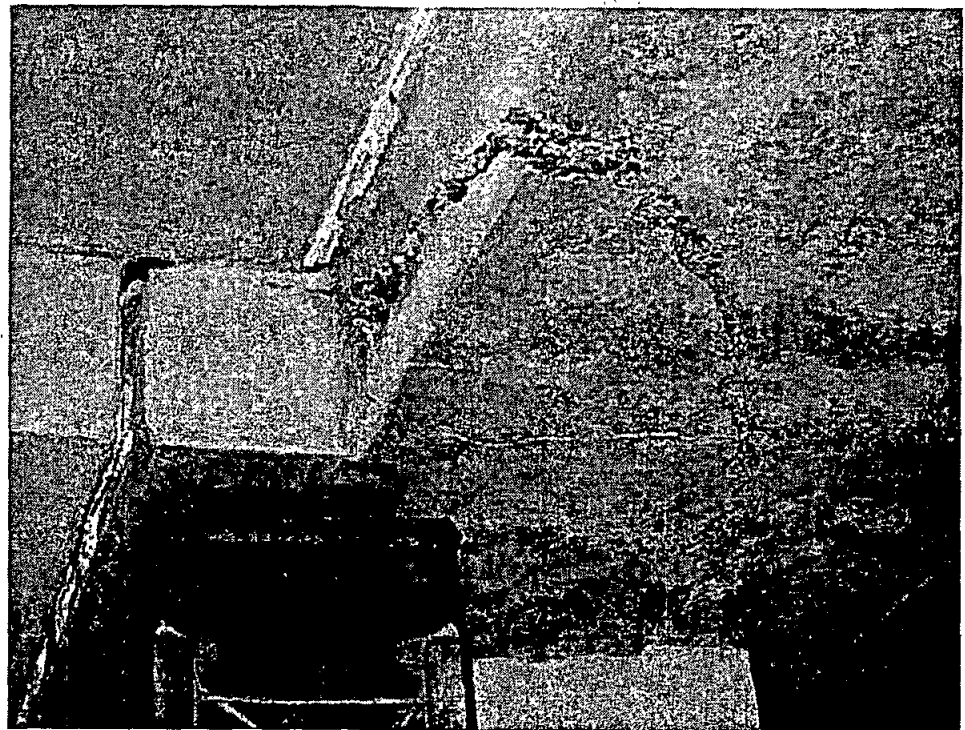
Bezweken nok van as 11 ter plaatse van as J; bovenste foto zijde as I –
